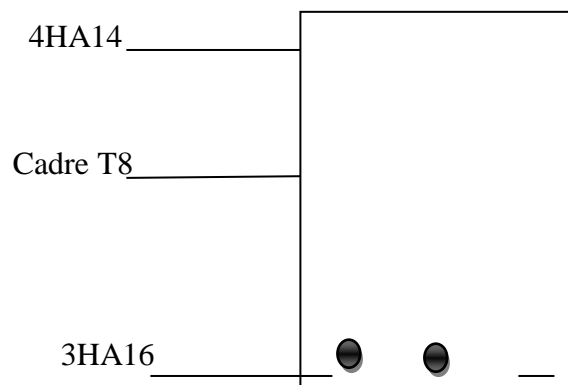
Ferraillage de la Poutre secondaire (35x35)
